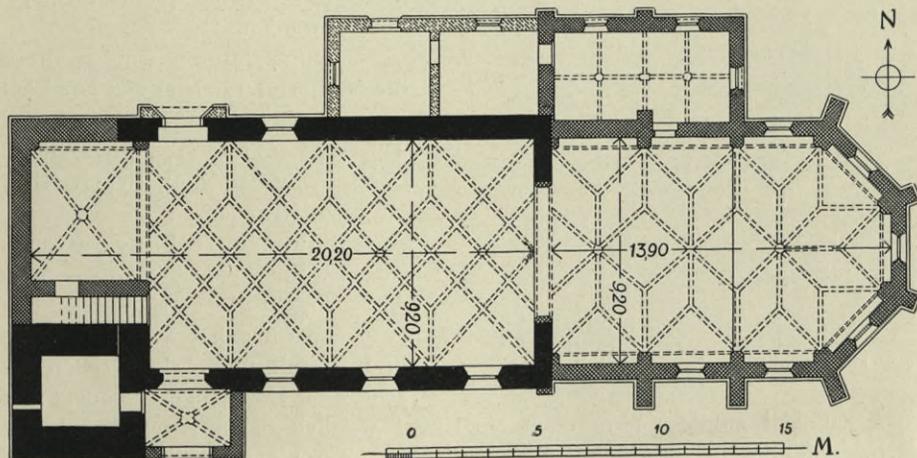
Altheim. Pfarrkirche. Grundriß.
